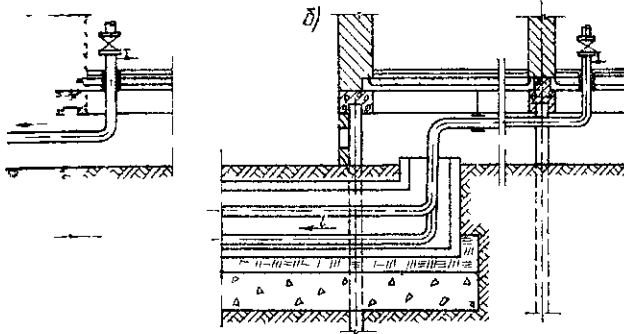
Вводы трубопроводов в здание с проветриваемым подпольем при прокладке труб
